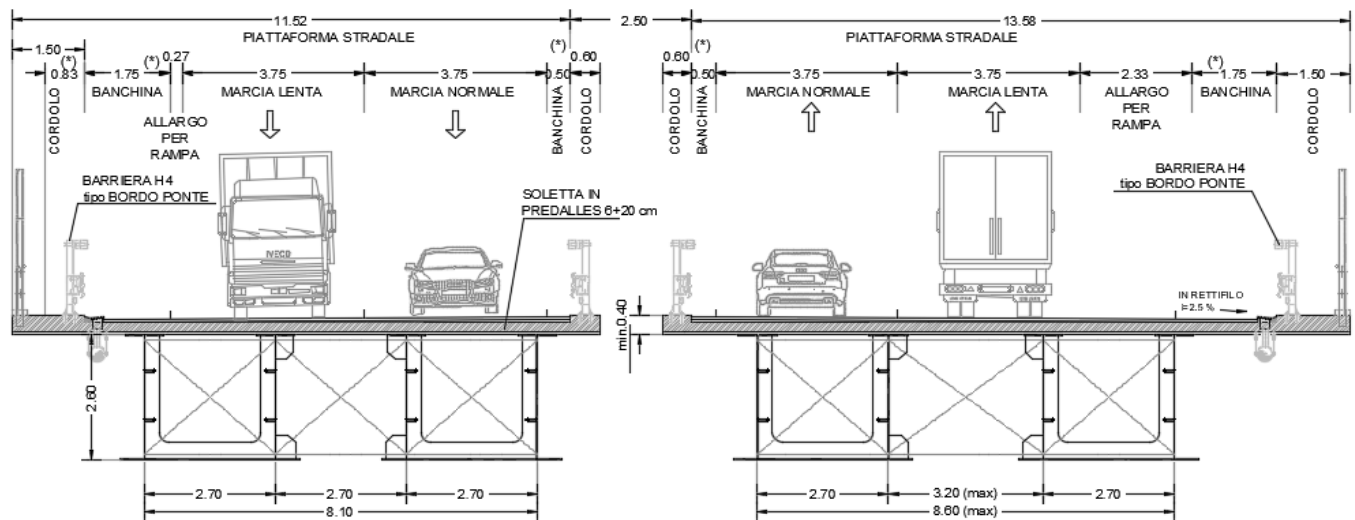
Sezione del Cavalcaferrovia Camisano
